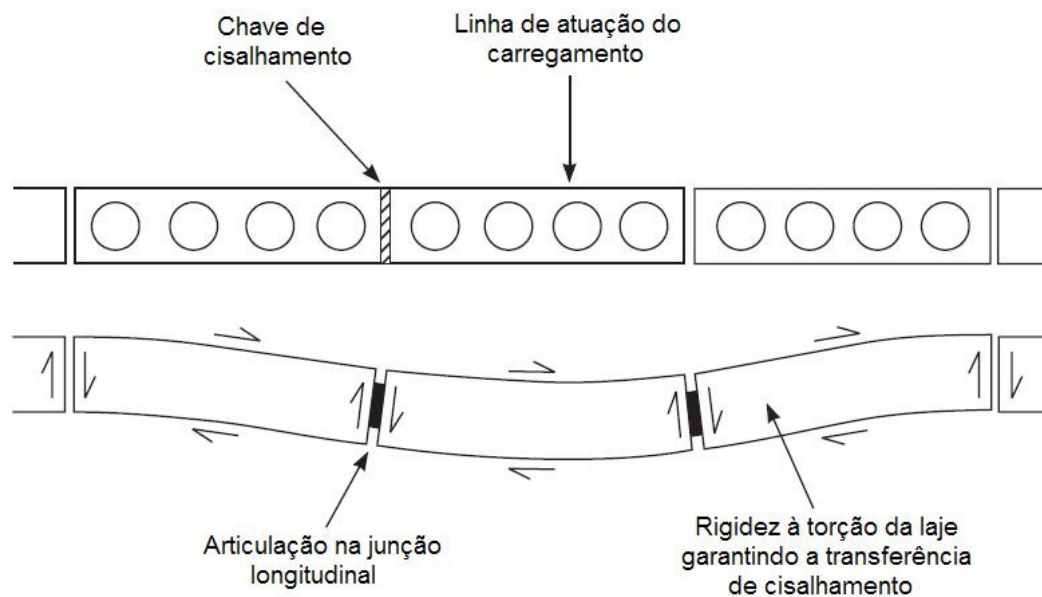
Pavimento de laje alveolar sem capa e com função de diafragma rígido. Detalhe da chave de cisalhamento. Detalhe da seção transversal na região da ranhura no alvéolo. (Adaptada de ELLIOT (2002)).
